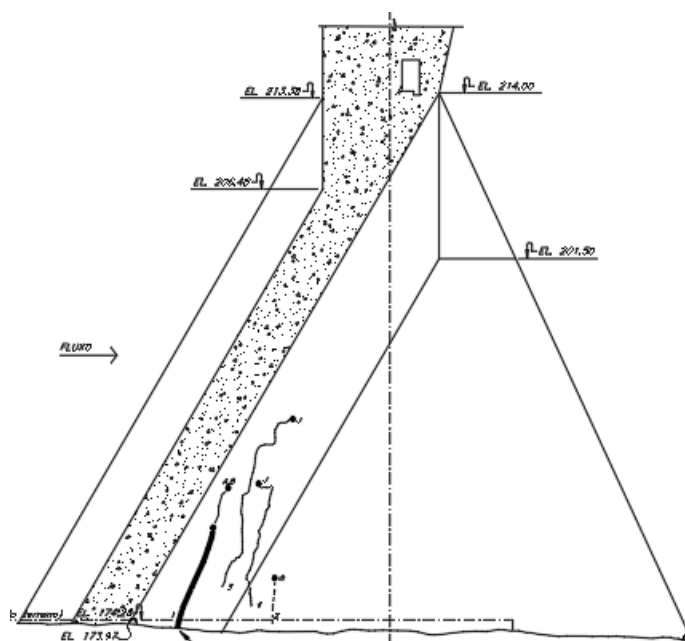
Mapeamento de fissuras – Bloco D38 – Face direita - Fonte: MENEZES e AKIO [48]
